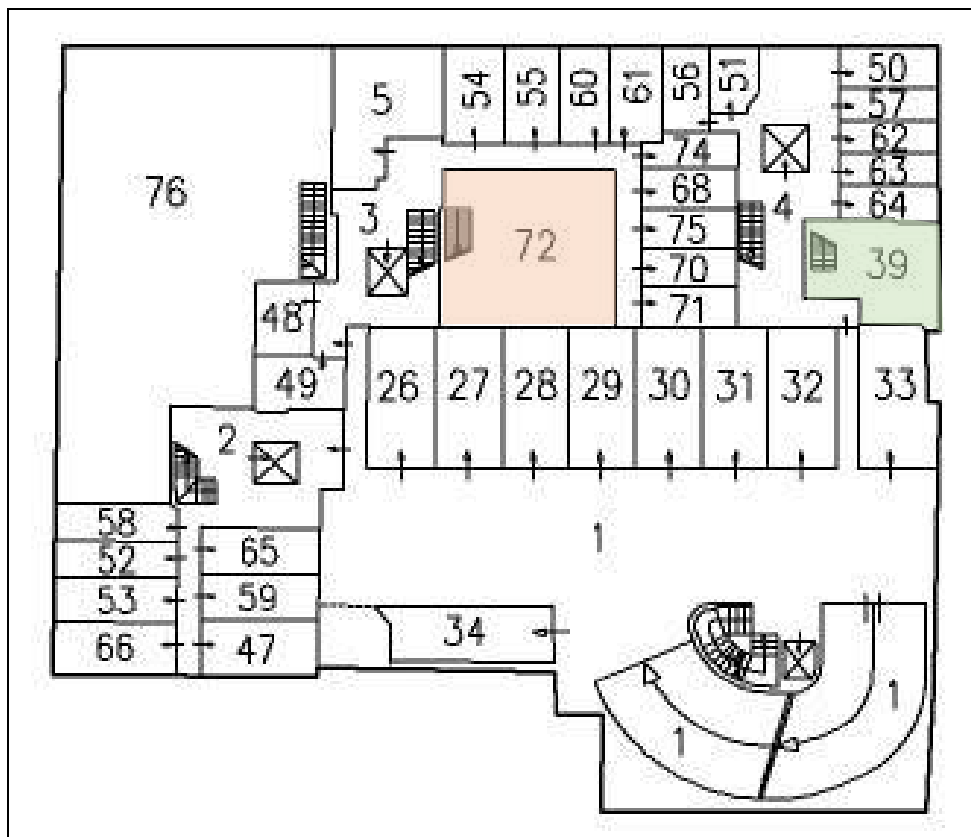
Estratto elaborato planimetrico: piano primo interrato – indicazione lotti
